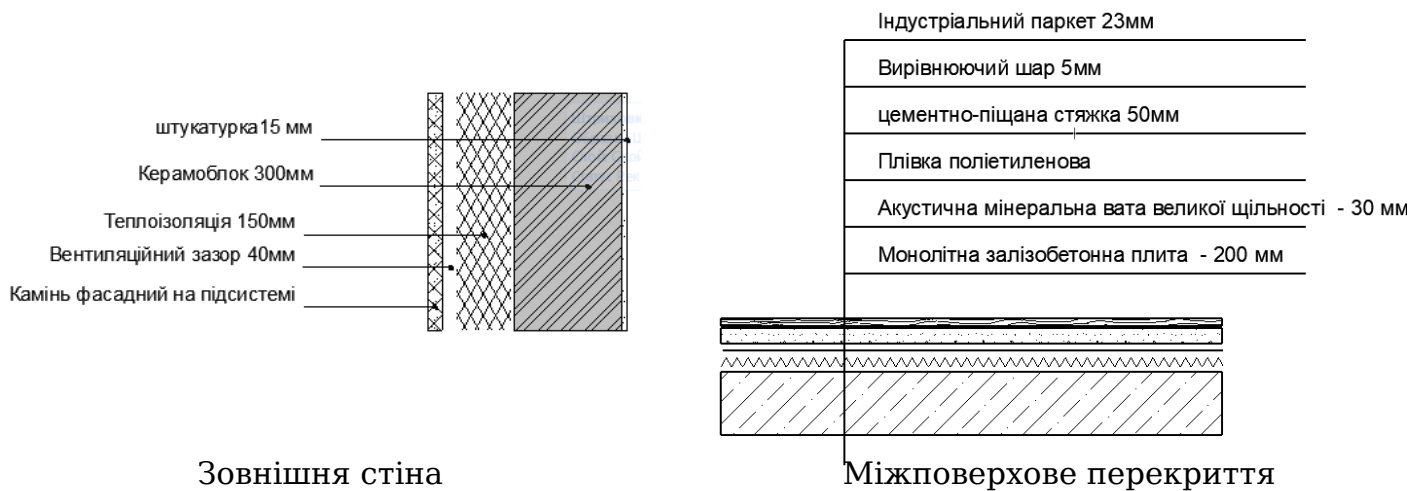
Схема матеріалів зовнішньої стіни та перекриття
